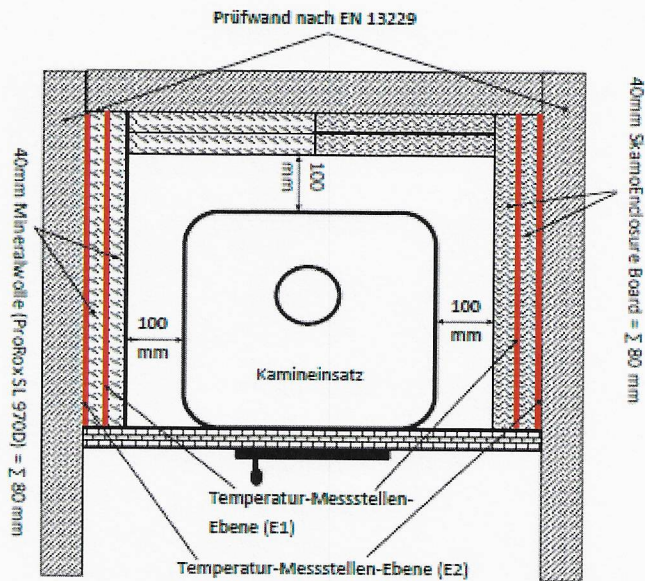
Draufsicht-Schnitt: Prüfaufbau Versuchstag 1: 80 mm SkamoEnclosure Board und 80 mm Mineralwolle
